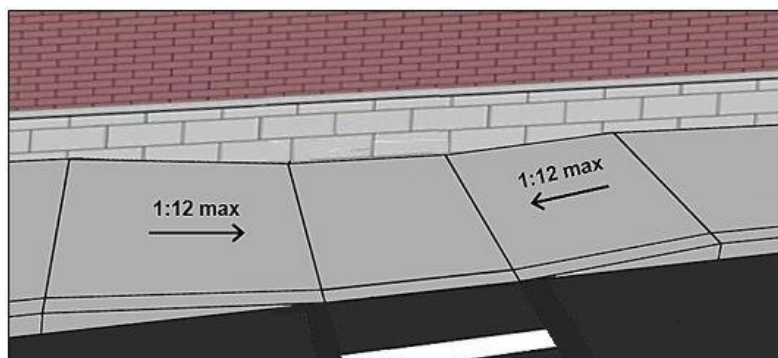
Устройство горизонтальной площадки для съезда на проезжую часть на кресле-коляске
